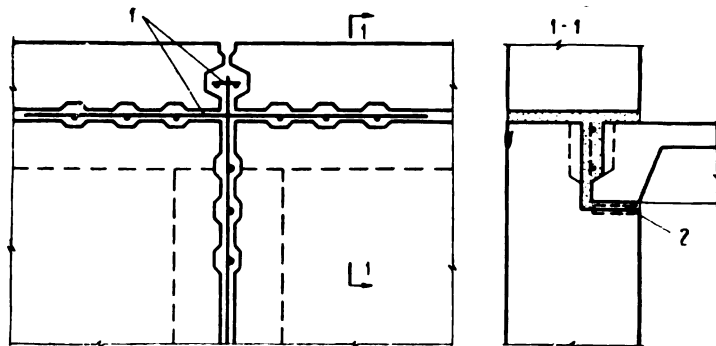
Железобетонная шпоночная монолитная связь между панелями стен и перекрытий в домах серии 1-480А
